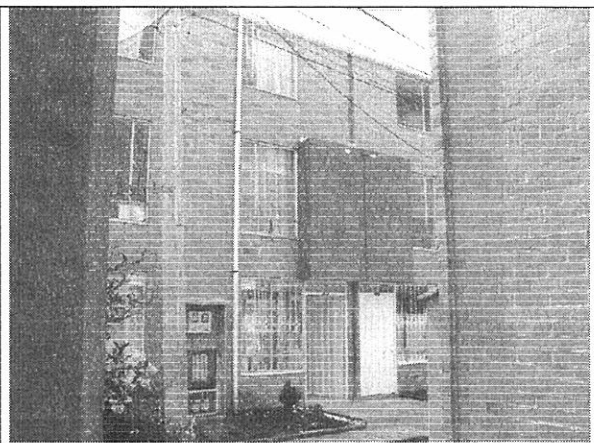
Fachada interna hacia la circulación central del conjunto residencial
